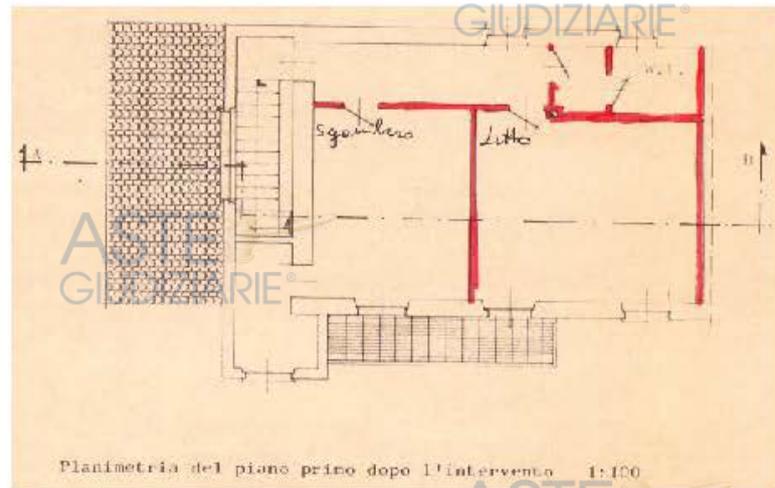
Estratto situazione autorizzata con Autorizzazione 79 del 23/01/1992 – pianta piano primo
